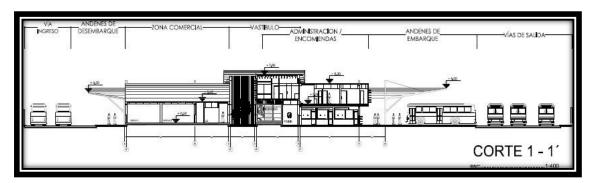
Planos del Terminal Tipo 3 para el cantón Archidona (Vista Lateral 1) Fuente: (Túqueres, 2017).
